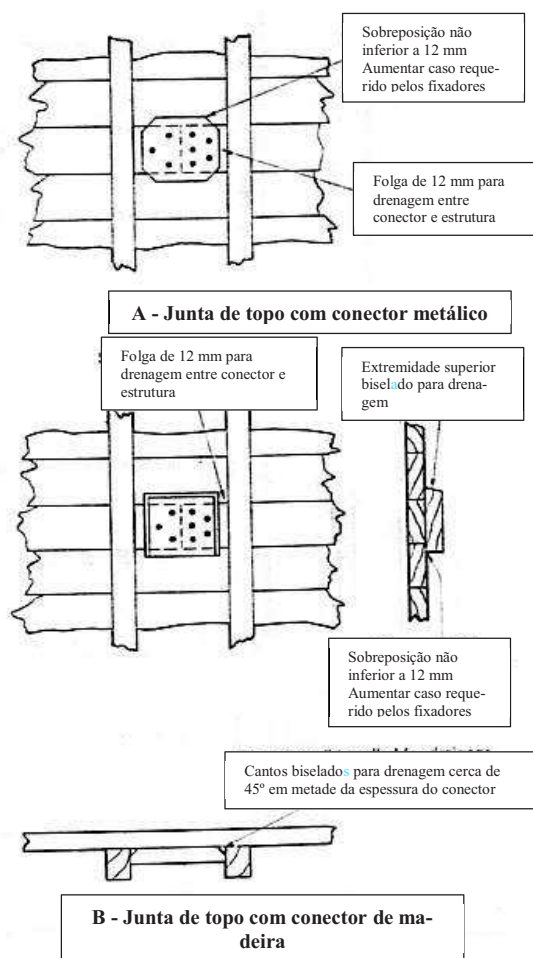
ARRANJO DAS FIXAÇÕES
